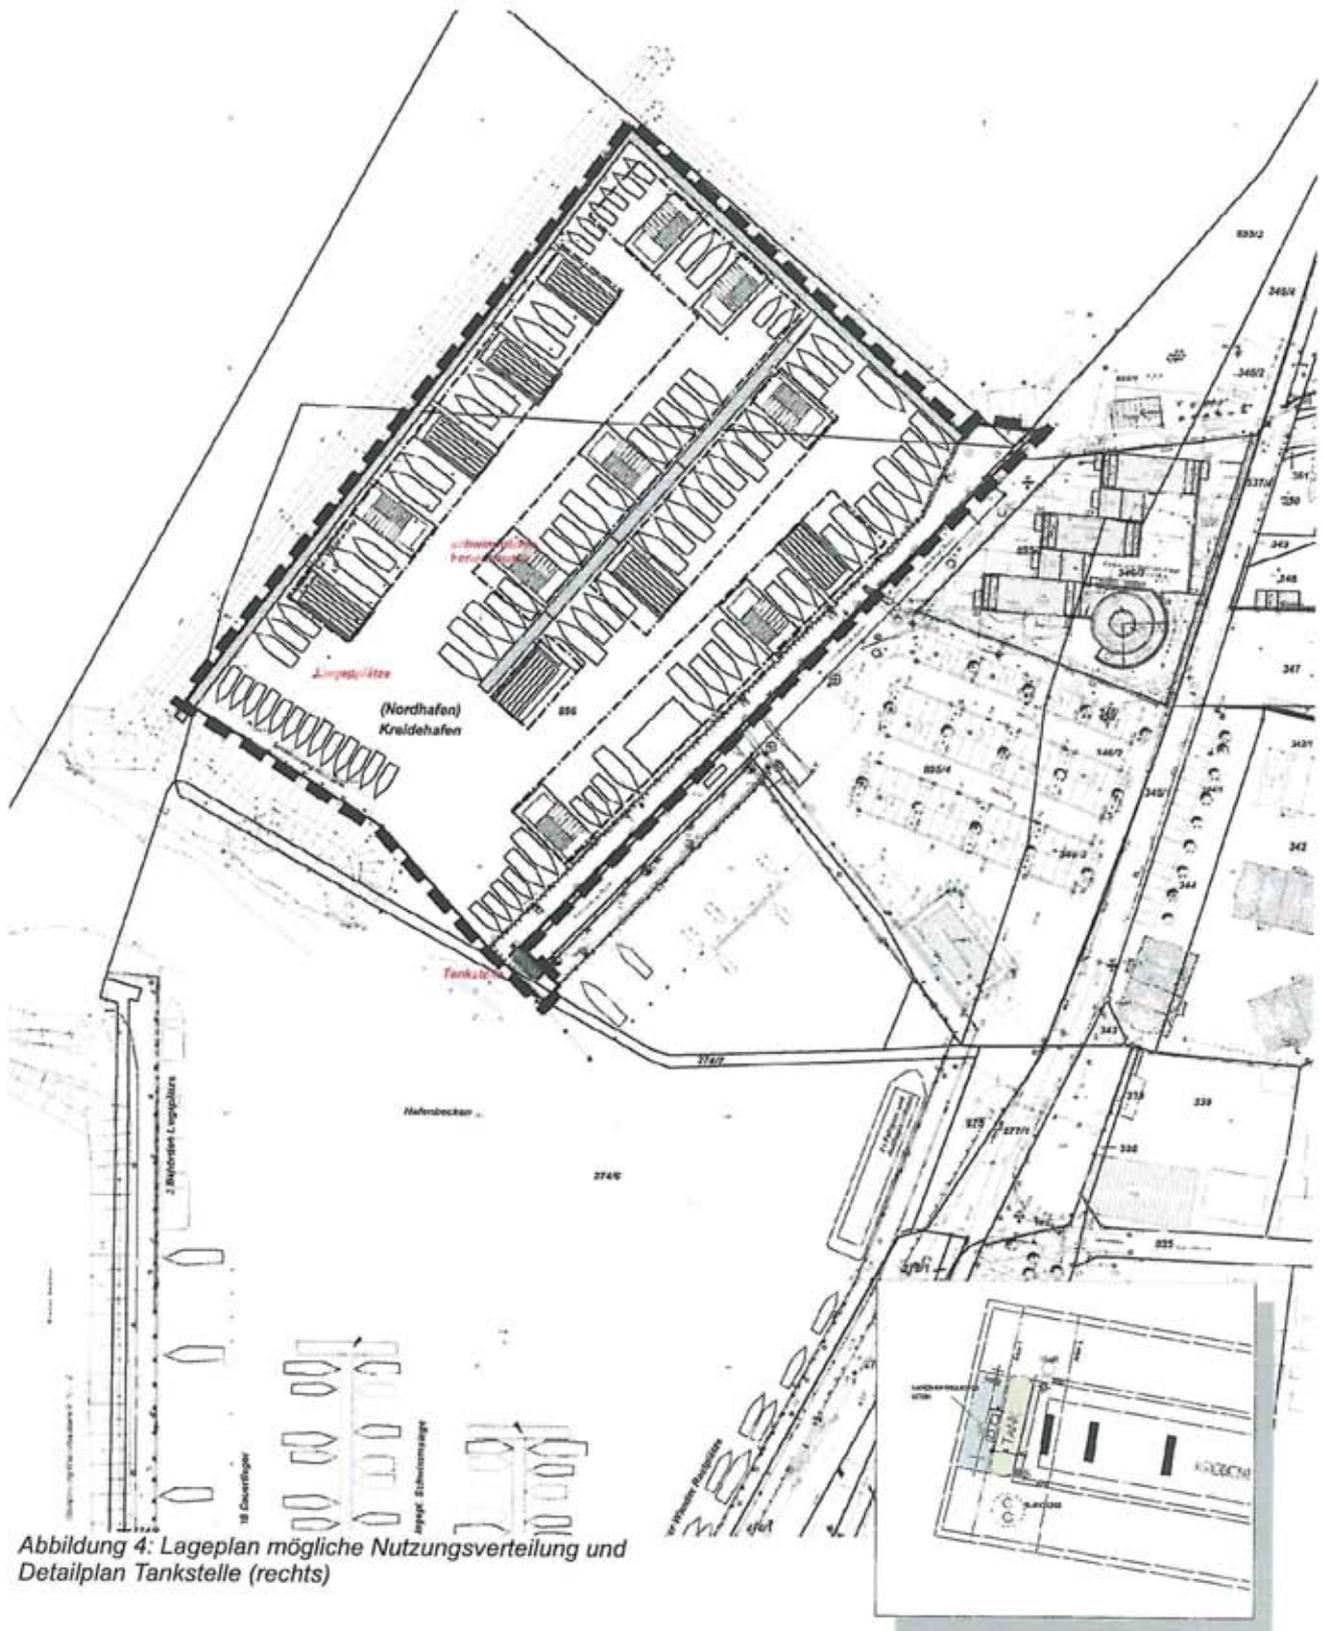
Lageplan mögliche Nutzungsverteilung und Detailplan Tankstelle (rechts)
